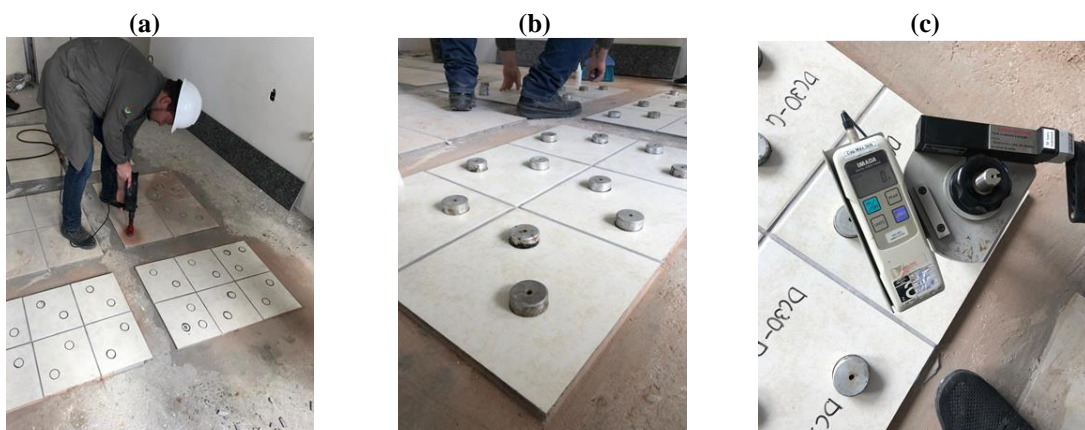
Execução de Ensaio de Aderência: (a) Corte da Placa Cerâmica, (b) Colagem da Pastilha Metálica, (c) Aplicação de Tensão com o Dinamômetro.
